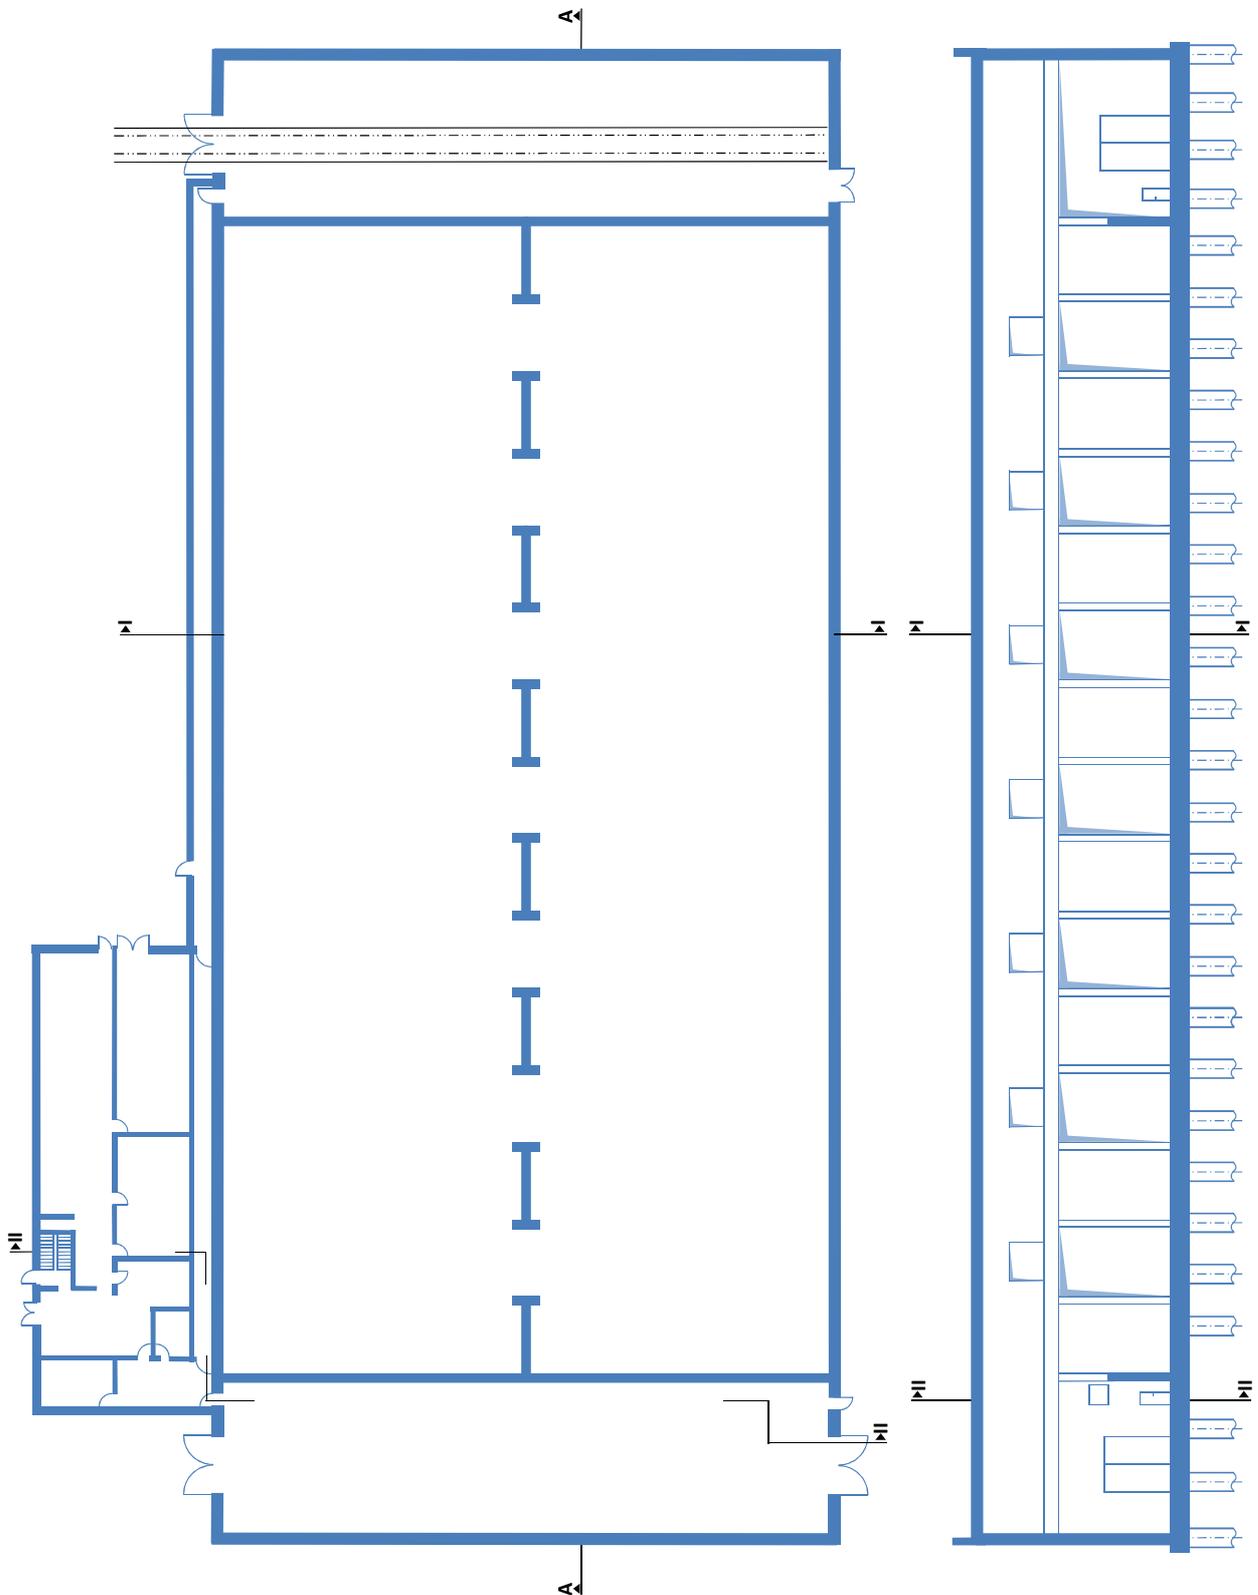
Grundriss und Längsschnitt LasMA
